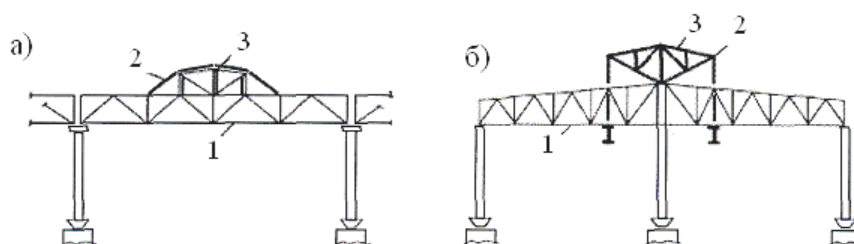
Варианты усиления стропильных ферм путем включения в работу светоаэрационных фонарей:
